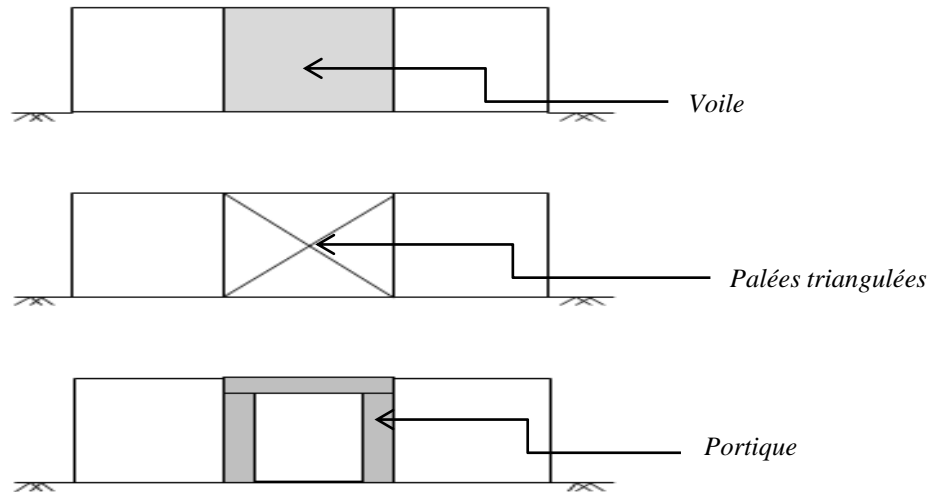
Stabilisation d'une file de poteaux par des éléments verticaux de contreventement
